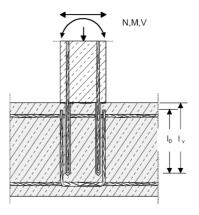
giunzione per sovrapposizione di pilastri sollecitati a flessione o muri a fondazioni.
